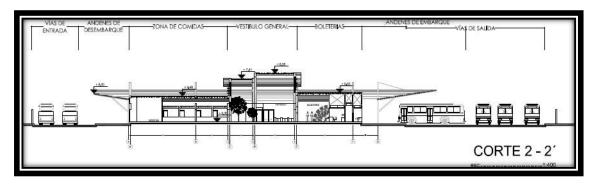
Planos del terminal Tipo 3 para el cantón Archidona (Vista Lateral 2) Fuente: (Túqueres, 2017).
